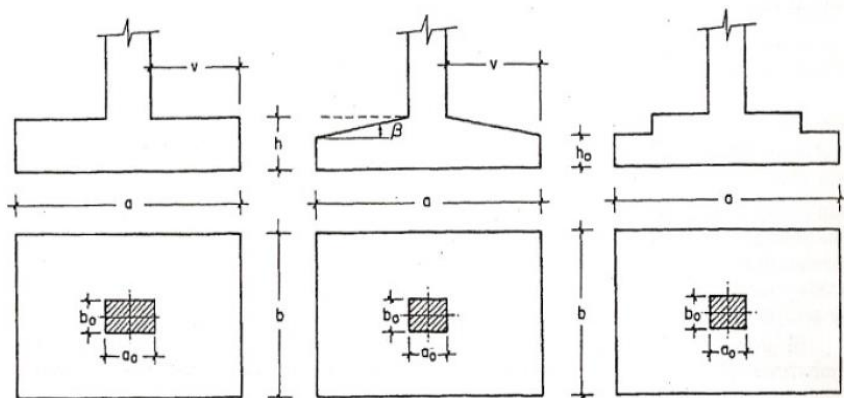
, Formas típicas de zapatas aisladas, Norma Boliviana del Hormigón Armado
